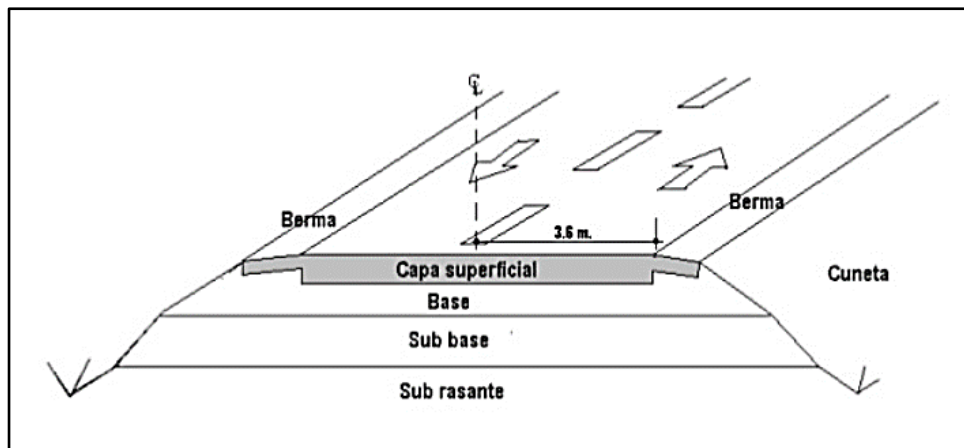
Estructura típica de un pavimento asfáltico (flexible)
